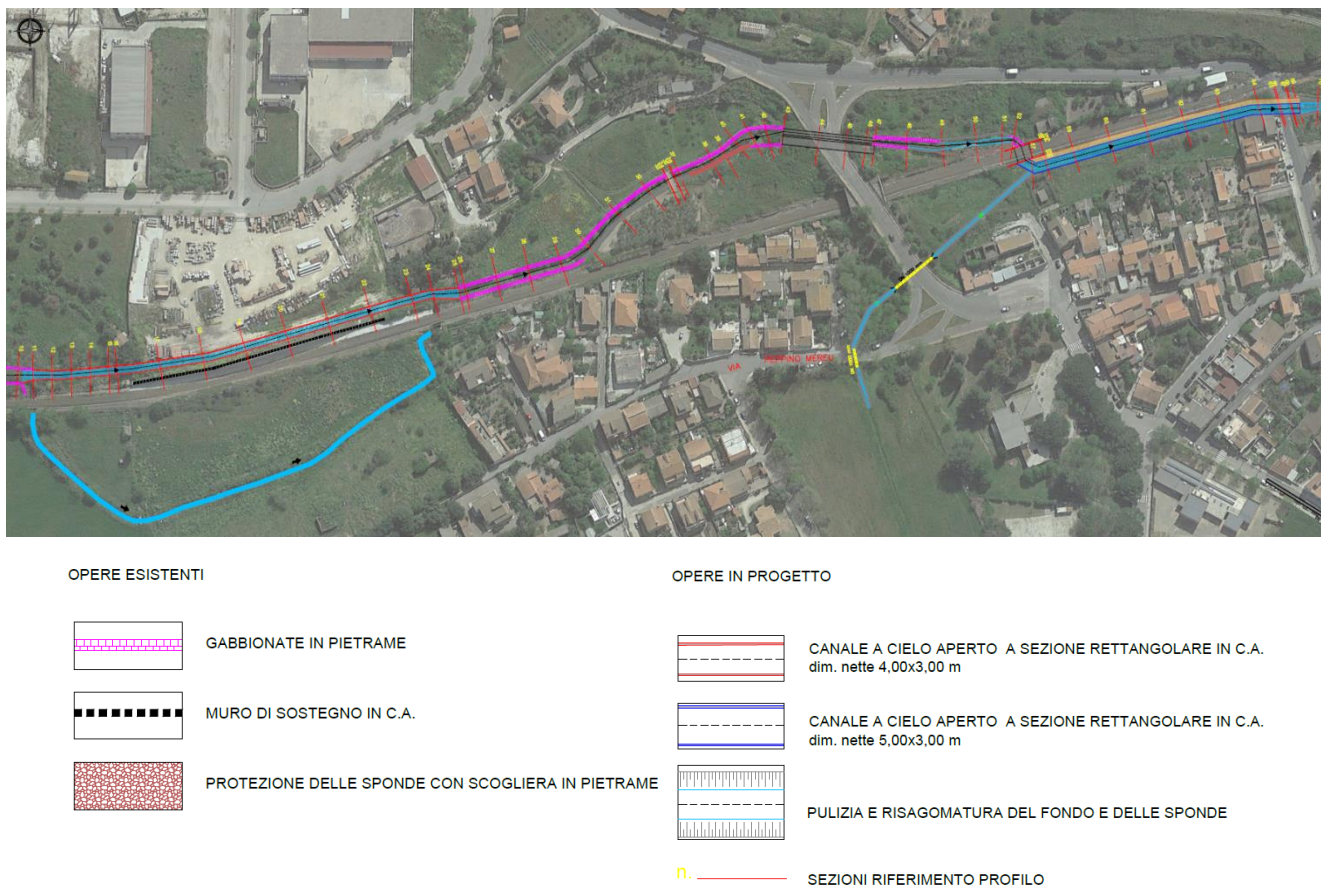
Planimetria d'intervento - Rio Calamasciu
